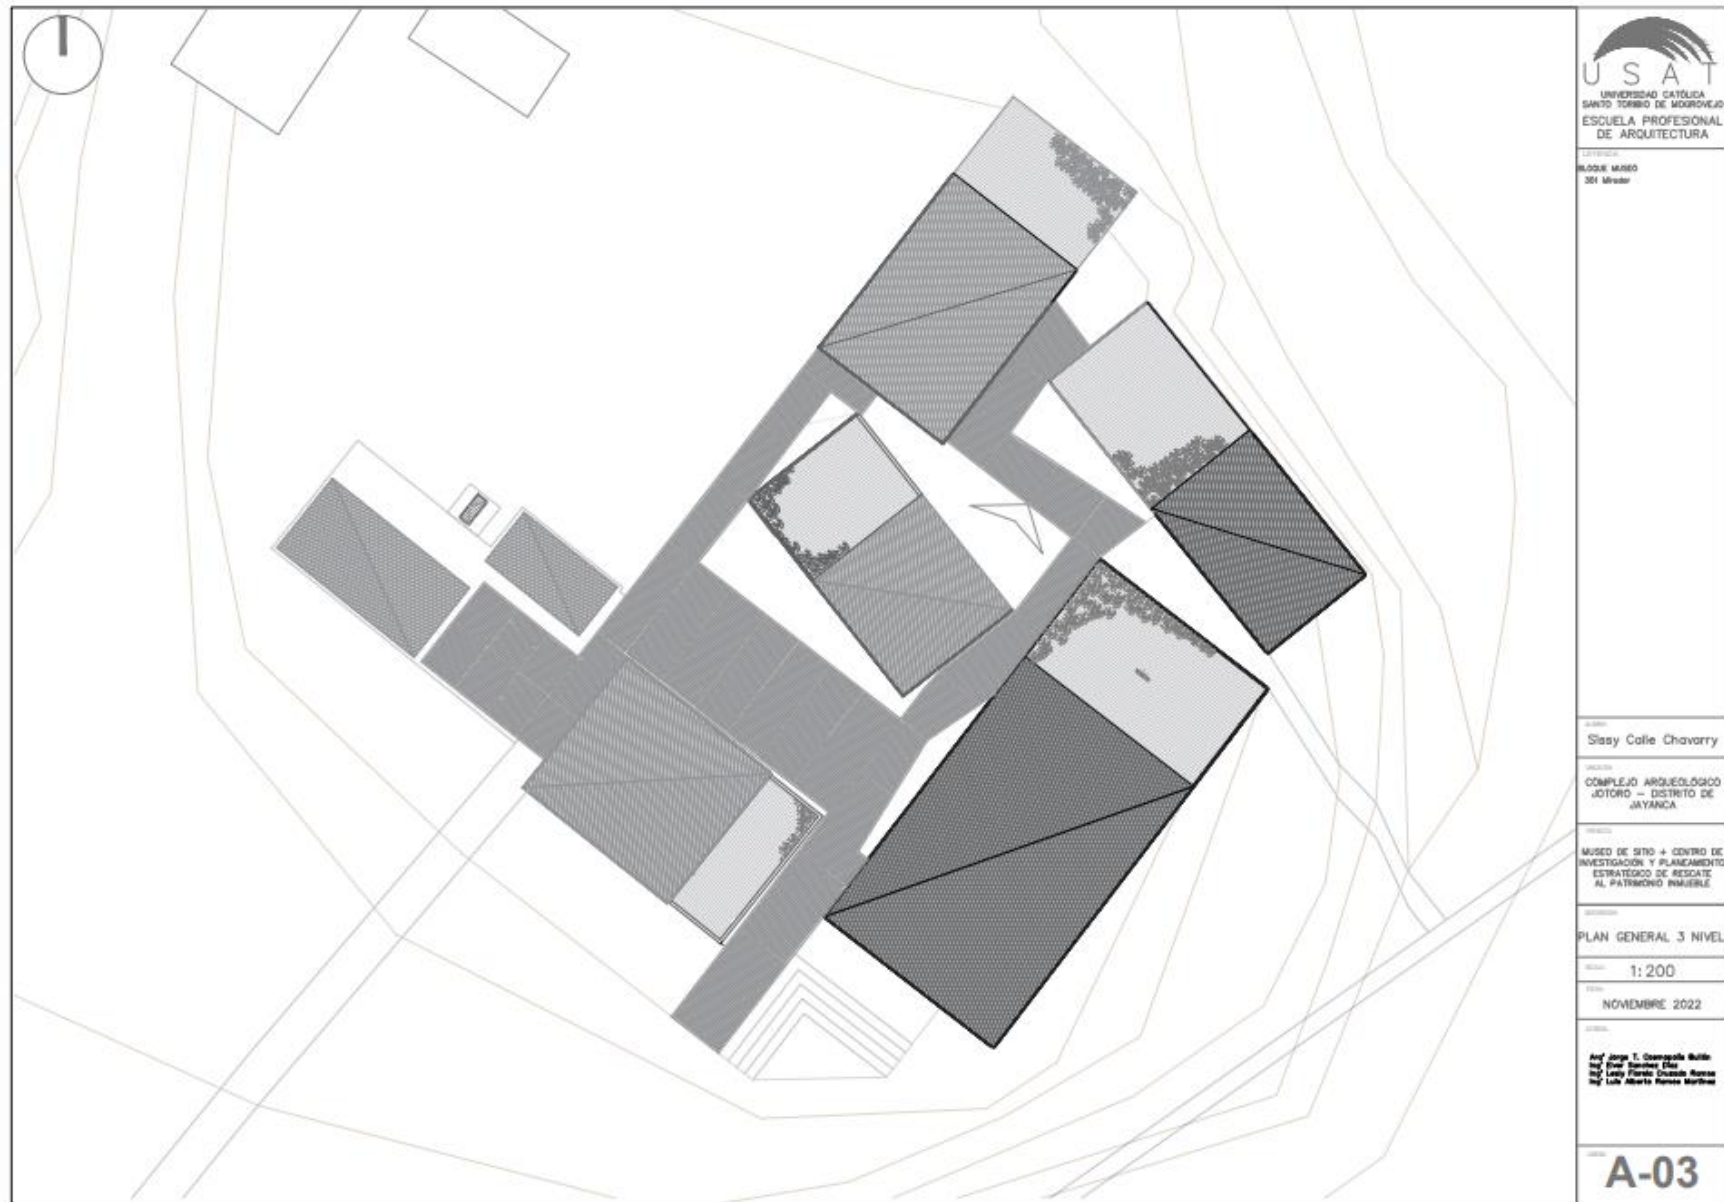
Planta arquitectónica 3er Nivel. Fuente: Propia
